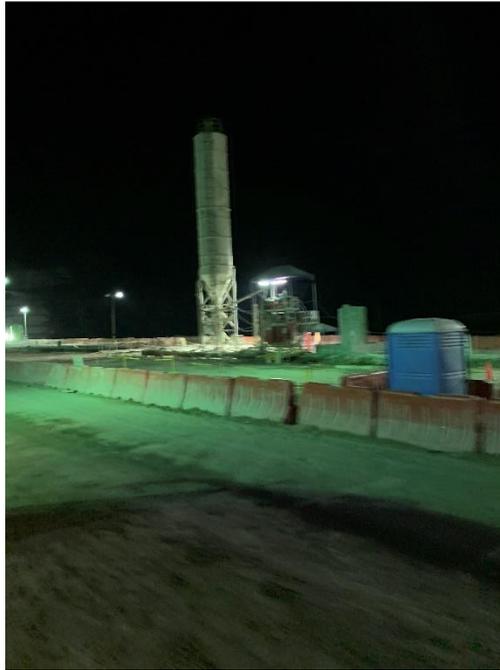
Trabajos de inyección de concreto en la parte superior del muro de la represa Hidroituango (Foto: Modesto Portilla Gamboa)
